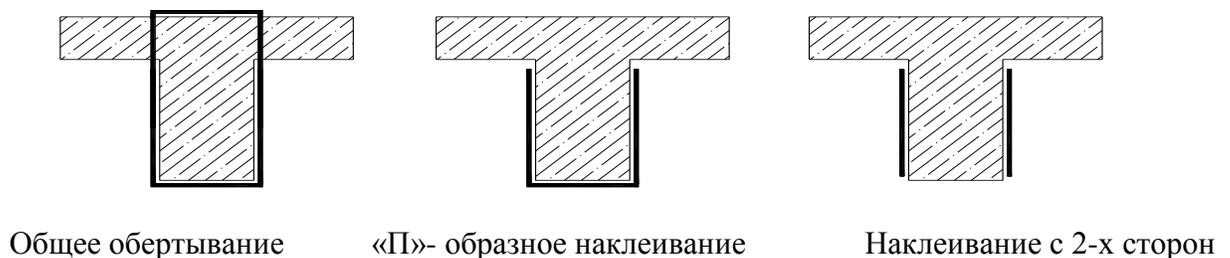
Схемы усиления СВА наклонных сечений изгибаемых элементов
